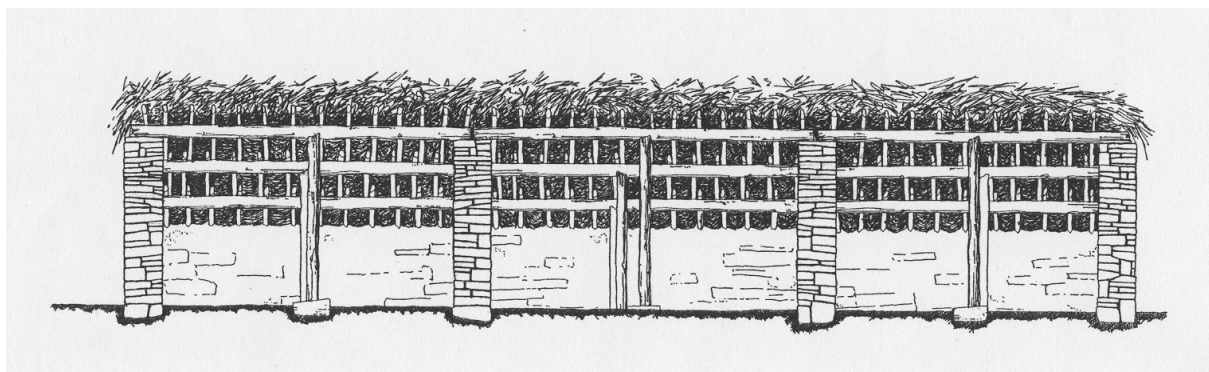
El Ceremeño, Herrería (Guadalajara). Propuesta de sección transversal.
